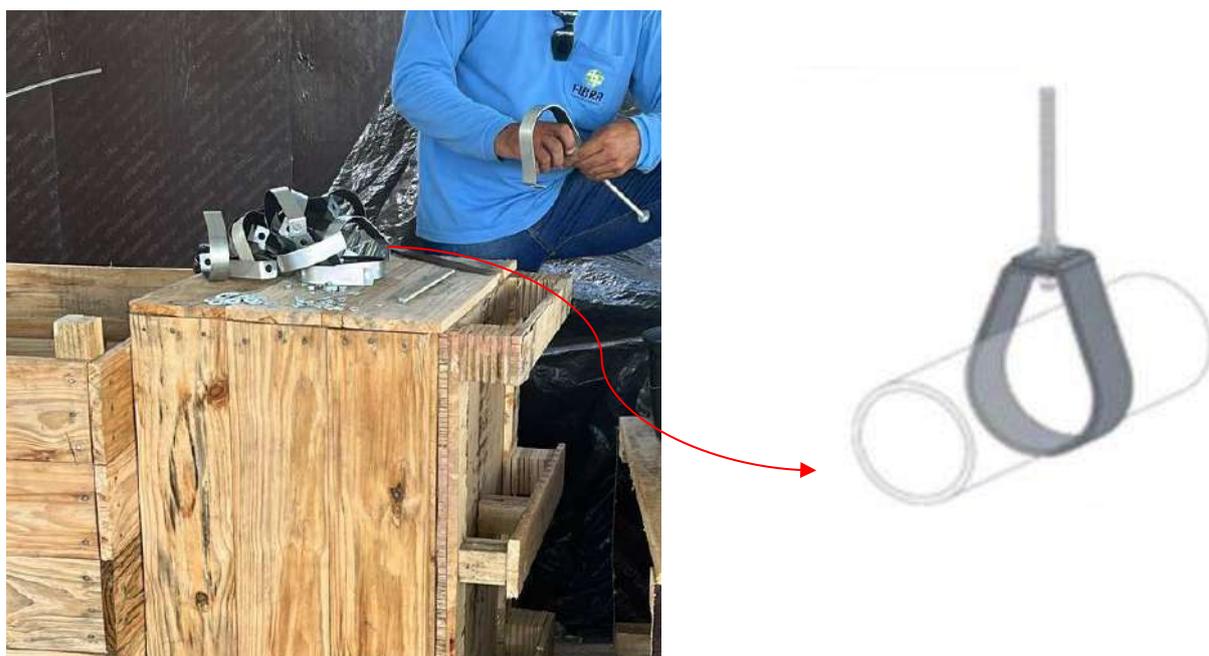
Abraçadeira em metal galvanizado tipo gota de 2.1/2” (Fonte: Autora)
